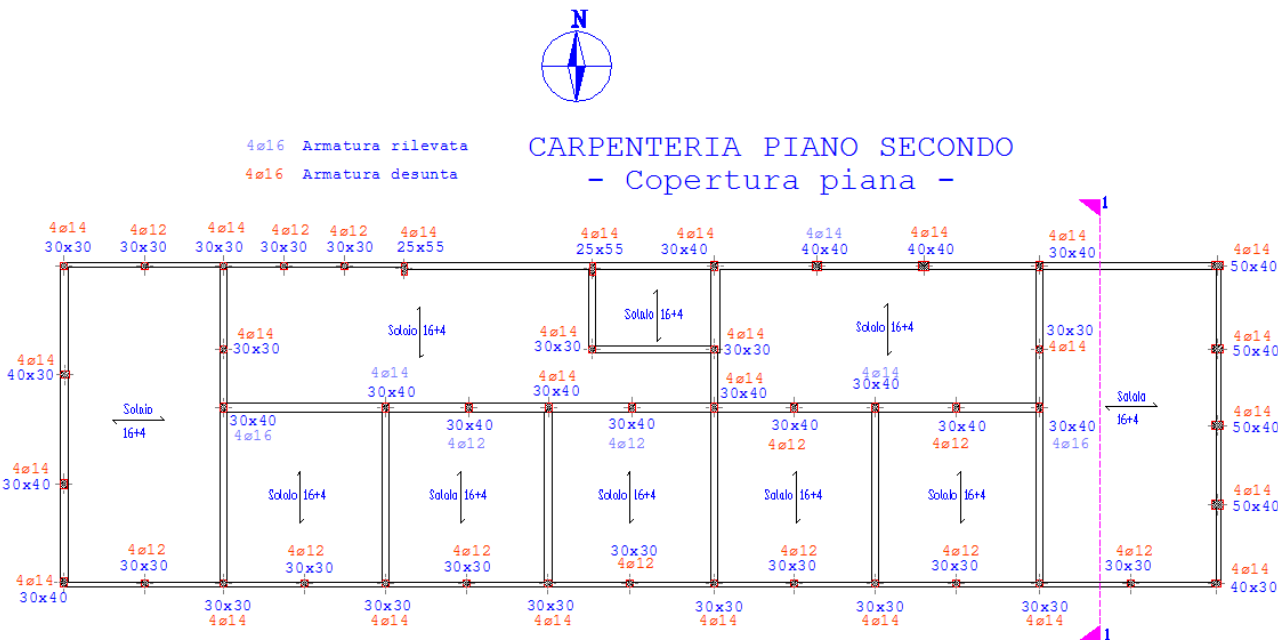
Armatura rilevata e presunta – carpenteria piano secondo (LC1)
